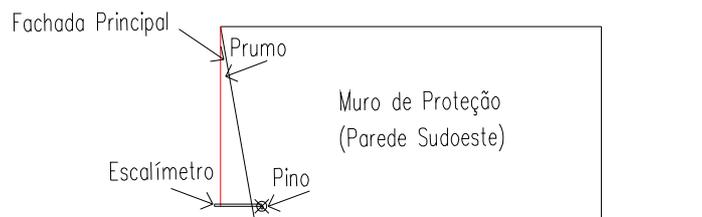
Esquema de medição do prumo - Vista lateral do muro.
